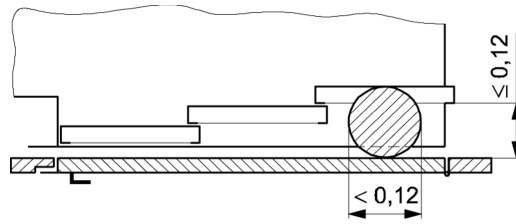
Schwenkende Etageschachttür und sich horizontal bewegende Lastträger-Schiebetür
